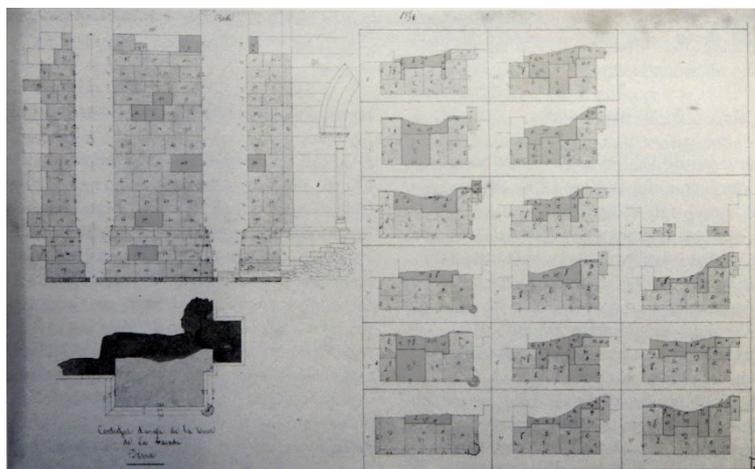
E.E. Viollet-Le-Duc, progetto di restauro della Chiesa della Madeleine di Vézelay; pianta prospetto e sezione a varie quote del contrafforte d'angolo della torre della facciata con l'indicazione della tessitura muraria e degli interventi (da E. VASSALLO, *Il progetto di Viollet-le-Duc per il restauro della Madeleine di Vézelay*, in G. FIENGO., A. BELLINI., S. DELLA TORRE, *la parabola del restauro stilistico*, Milano, Guerini editore, 1994, p.72).
